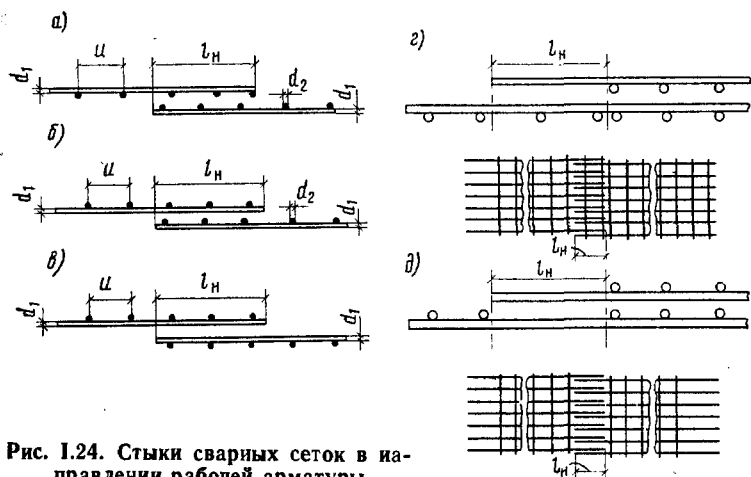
Стыки сварных сеток в направлении рабочей арматуры
